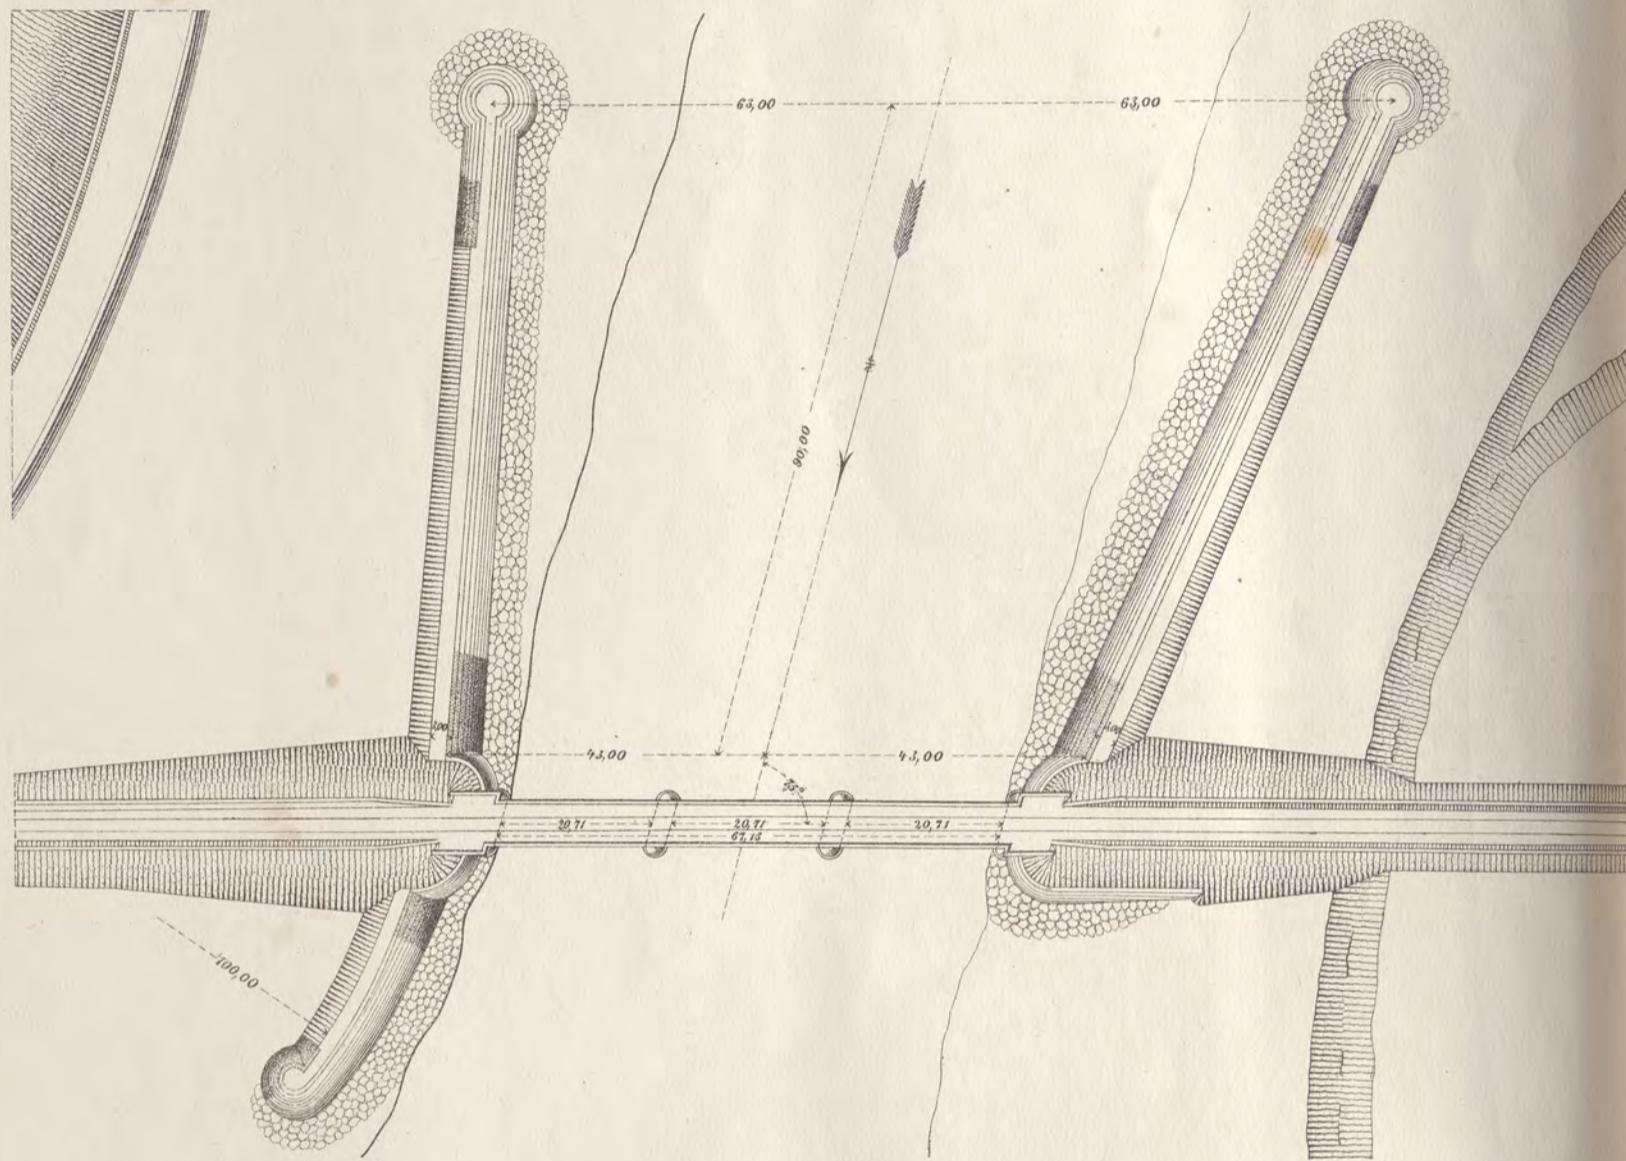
^a Proiezione orizzontale ed elevazione dell'argine di destra.
